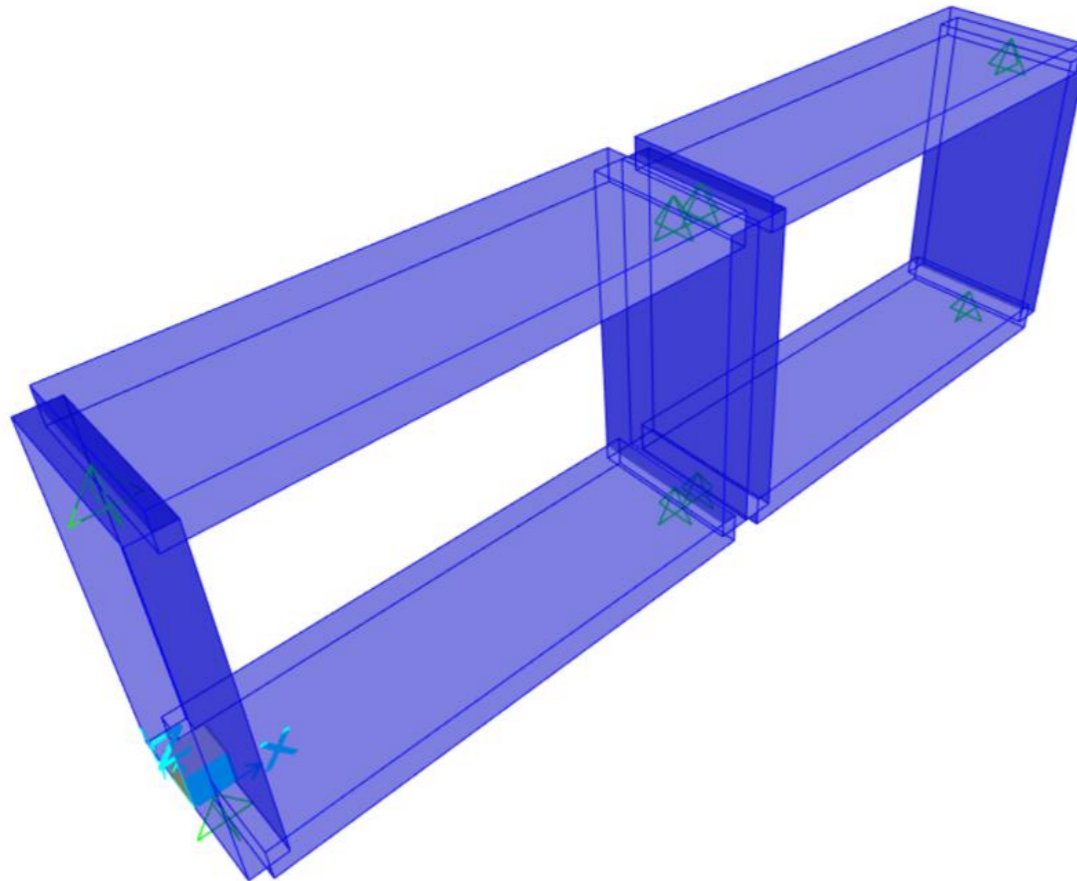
Sección en 3D del colector. Fuente: SAP2000
